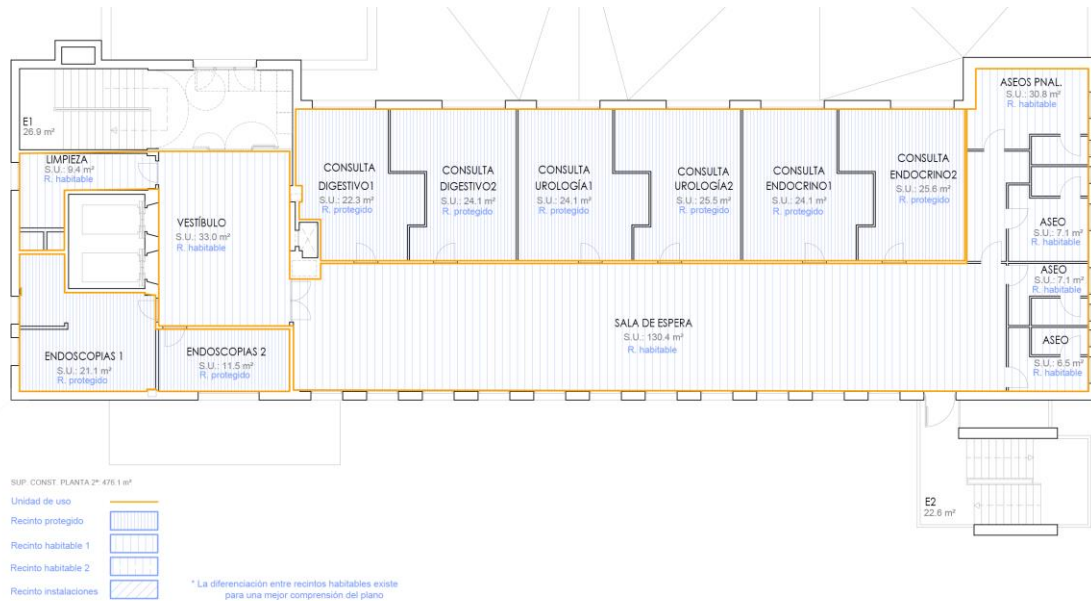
Planta de recintos de la planta segunda. (Planta tipo)
